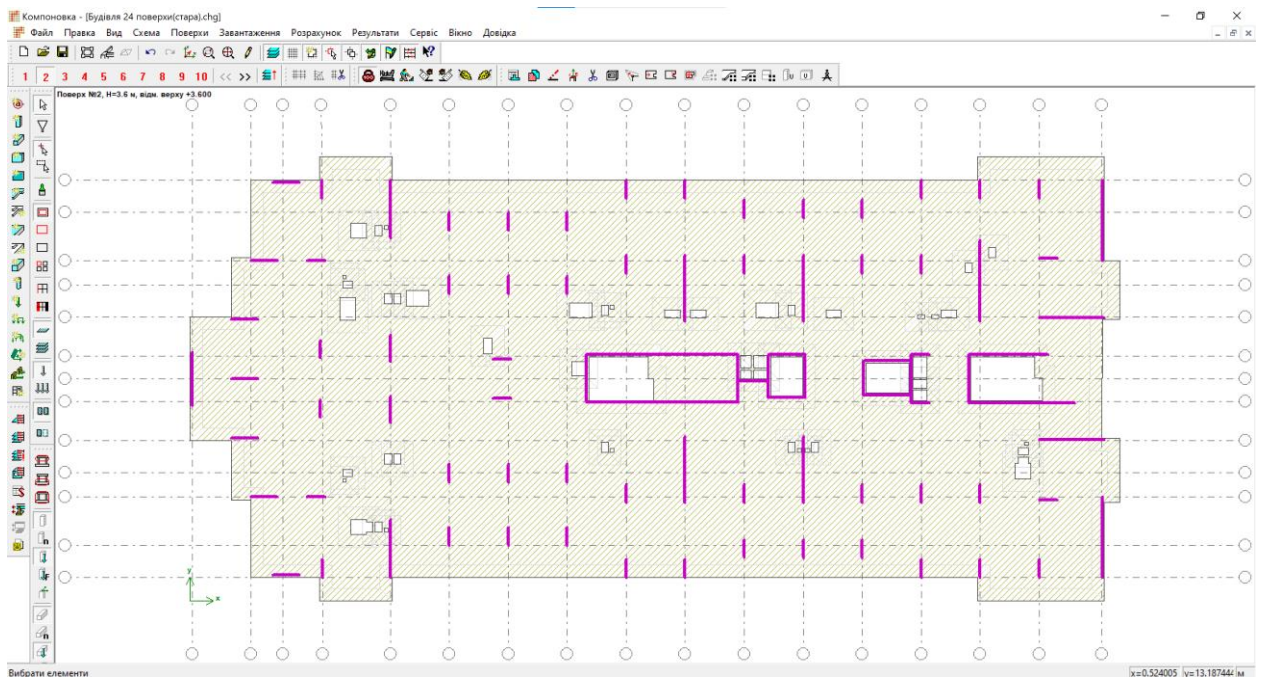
Імпорт типової плити перекриття в Компановка
